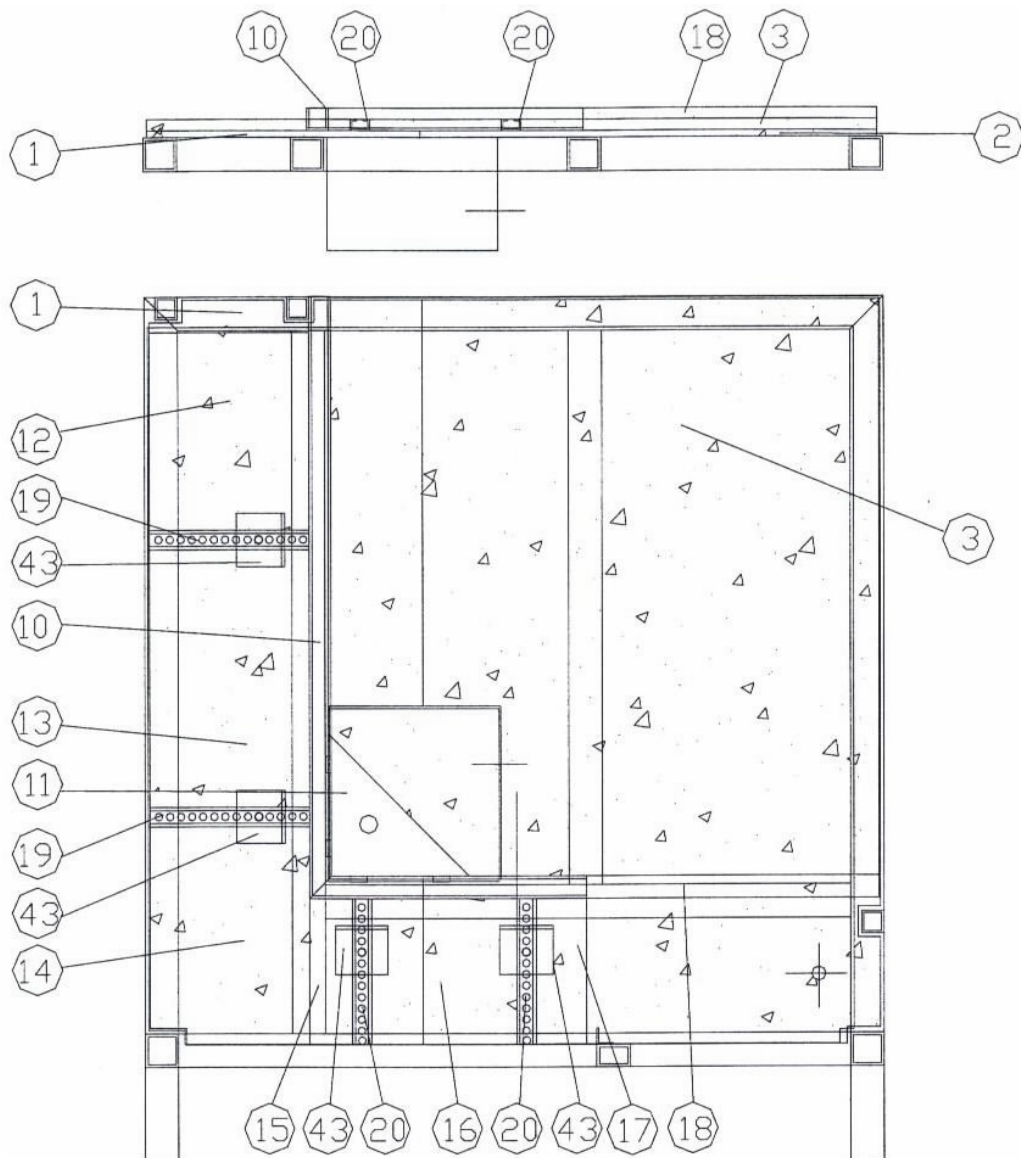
此圖為推車底座及底座框架的尺寸圖，為圖 16 中 Section CC 及 Section BB 的詳細圖。
